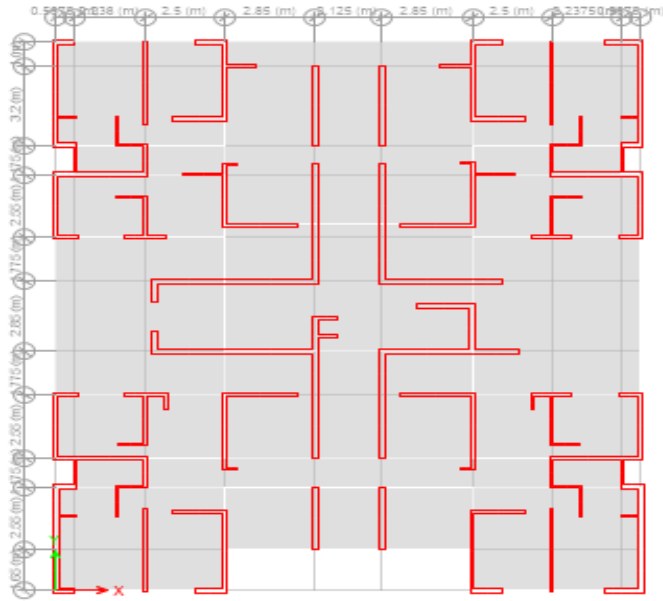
Vista en planta del modelamiento del edificio en ETABS 2016.
